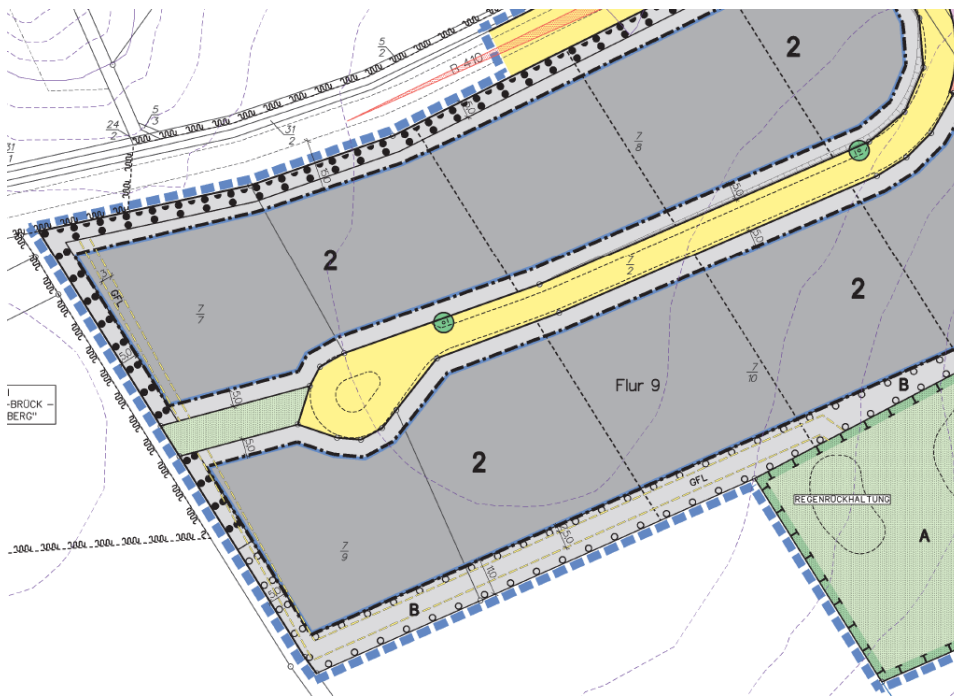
unmaßstäblicher Verkleinerung der ursprünglichen B-Plan Fassung
